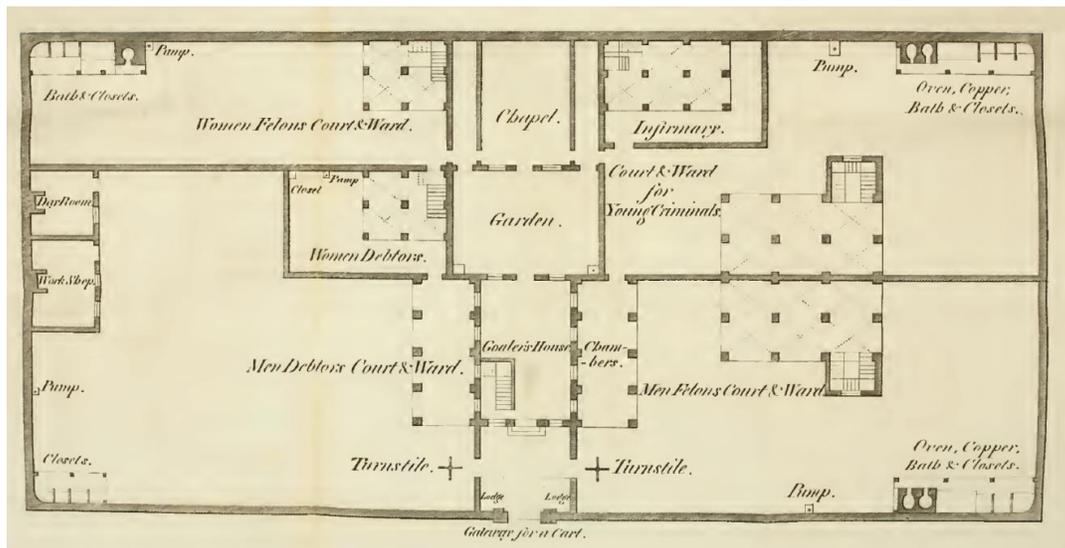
Plan para una prisión de Condado, John Howard (1777)
